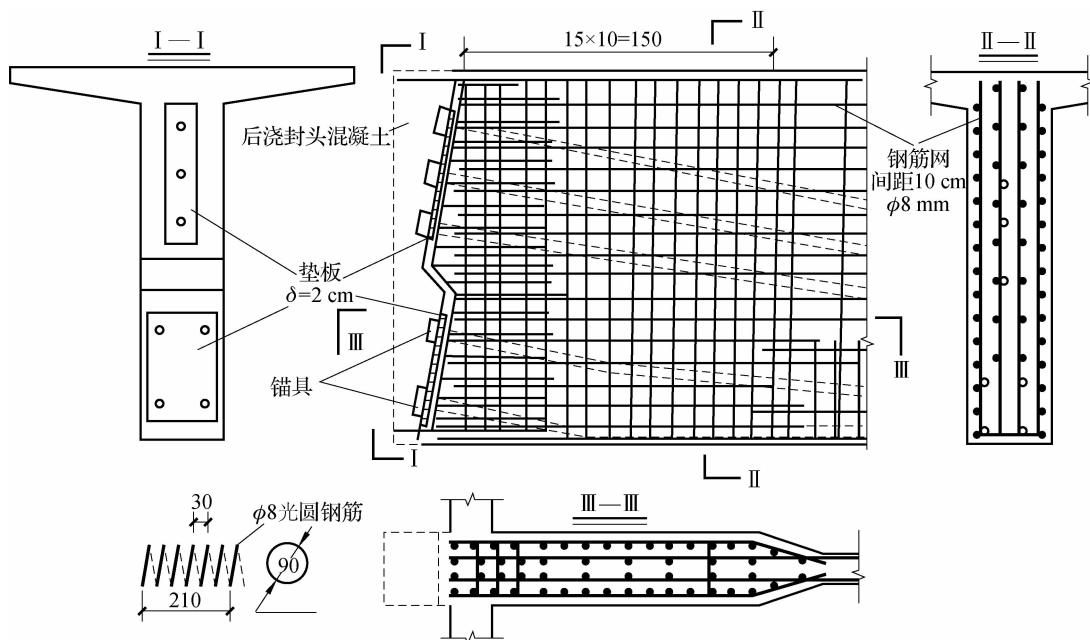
梁端的垫板和加强钢筋网(尺寸单位:mm)
